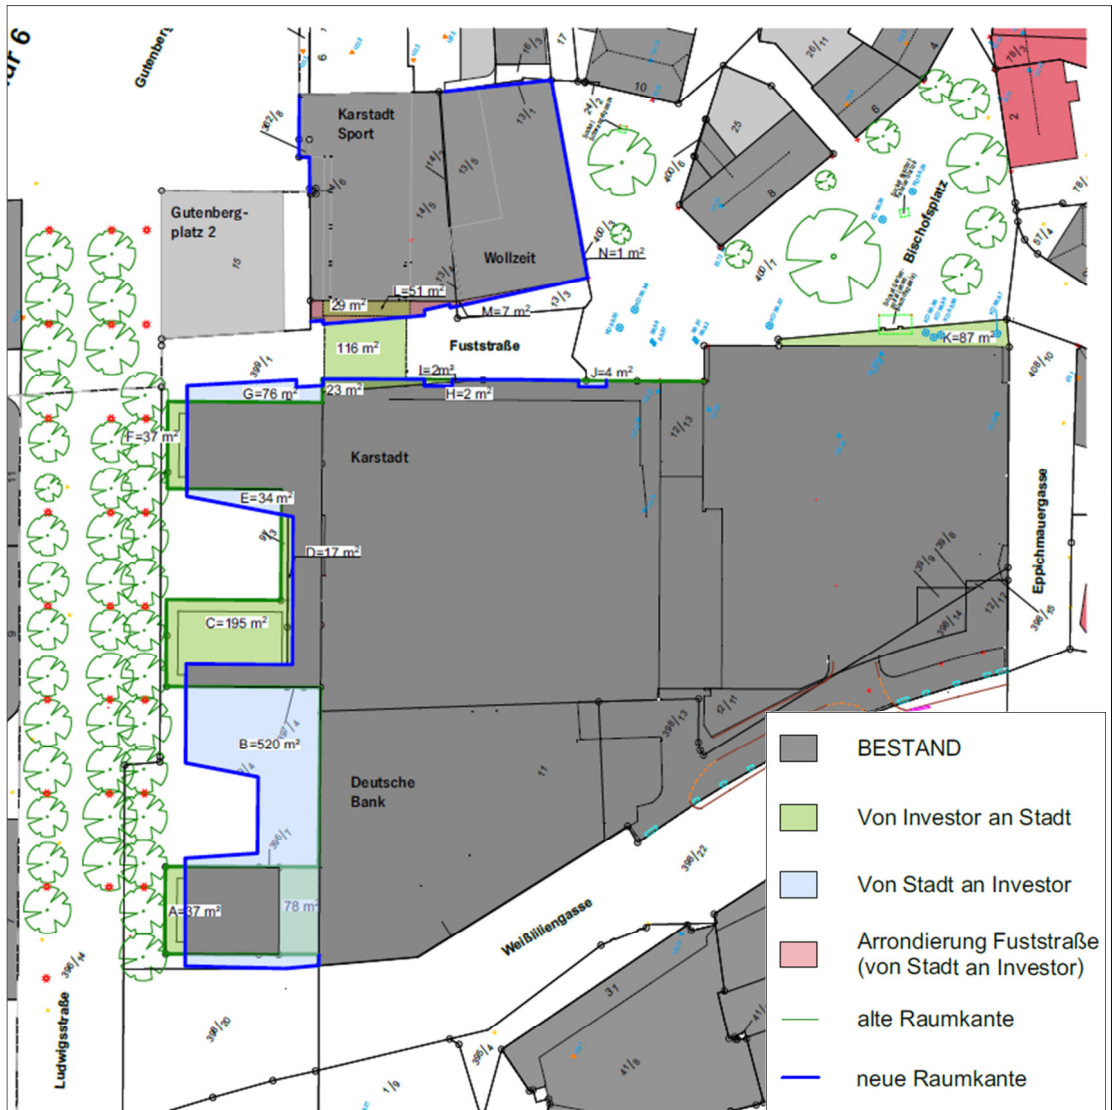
Grafische Darstellung Flächenbilanzierung (Quelle: Faerber Architekten GbR, Mainz, Planungsstand 17.09.2020).
